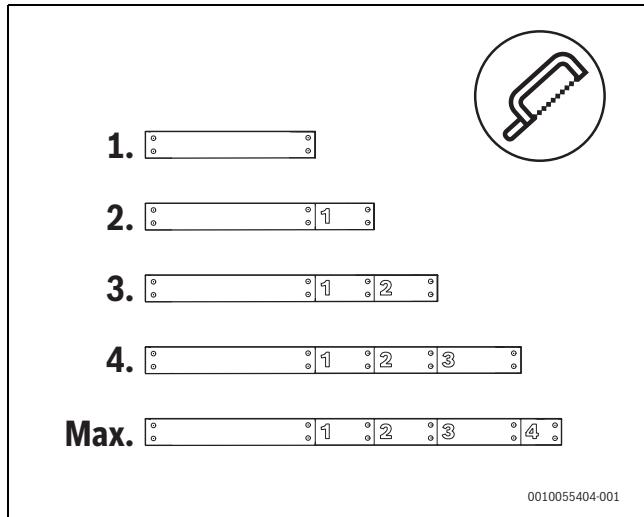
Longueurs des planches d'écartement de la fondation préfabriquée
